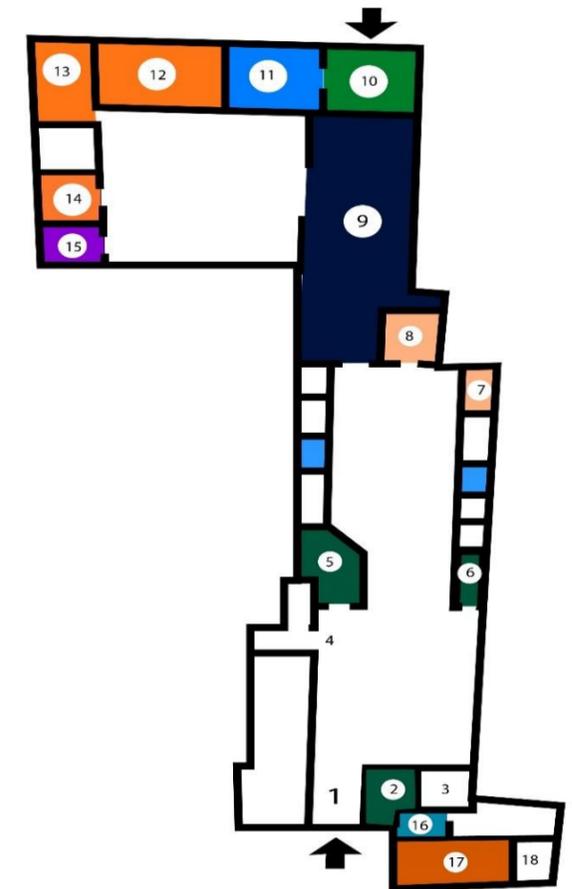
DISTRIBUCIÓN SEGÚN PLANTA
